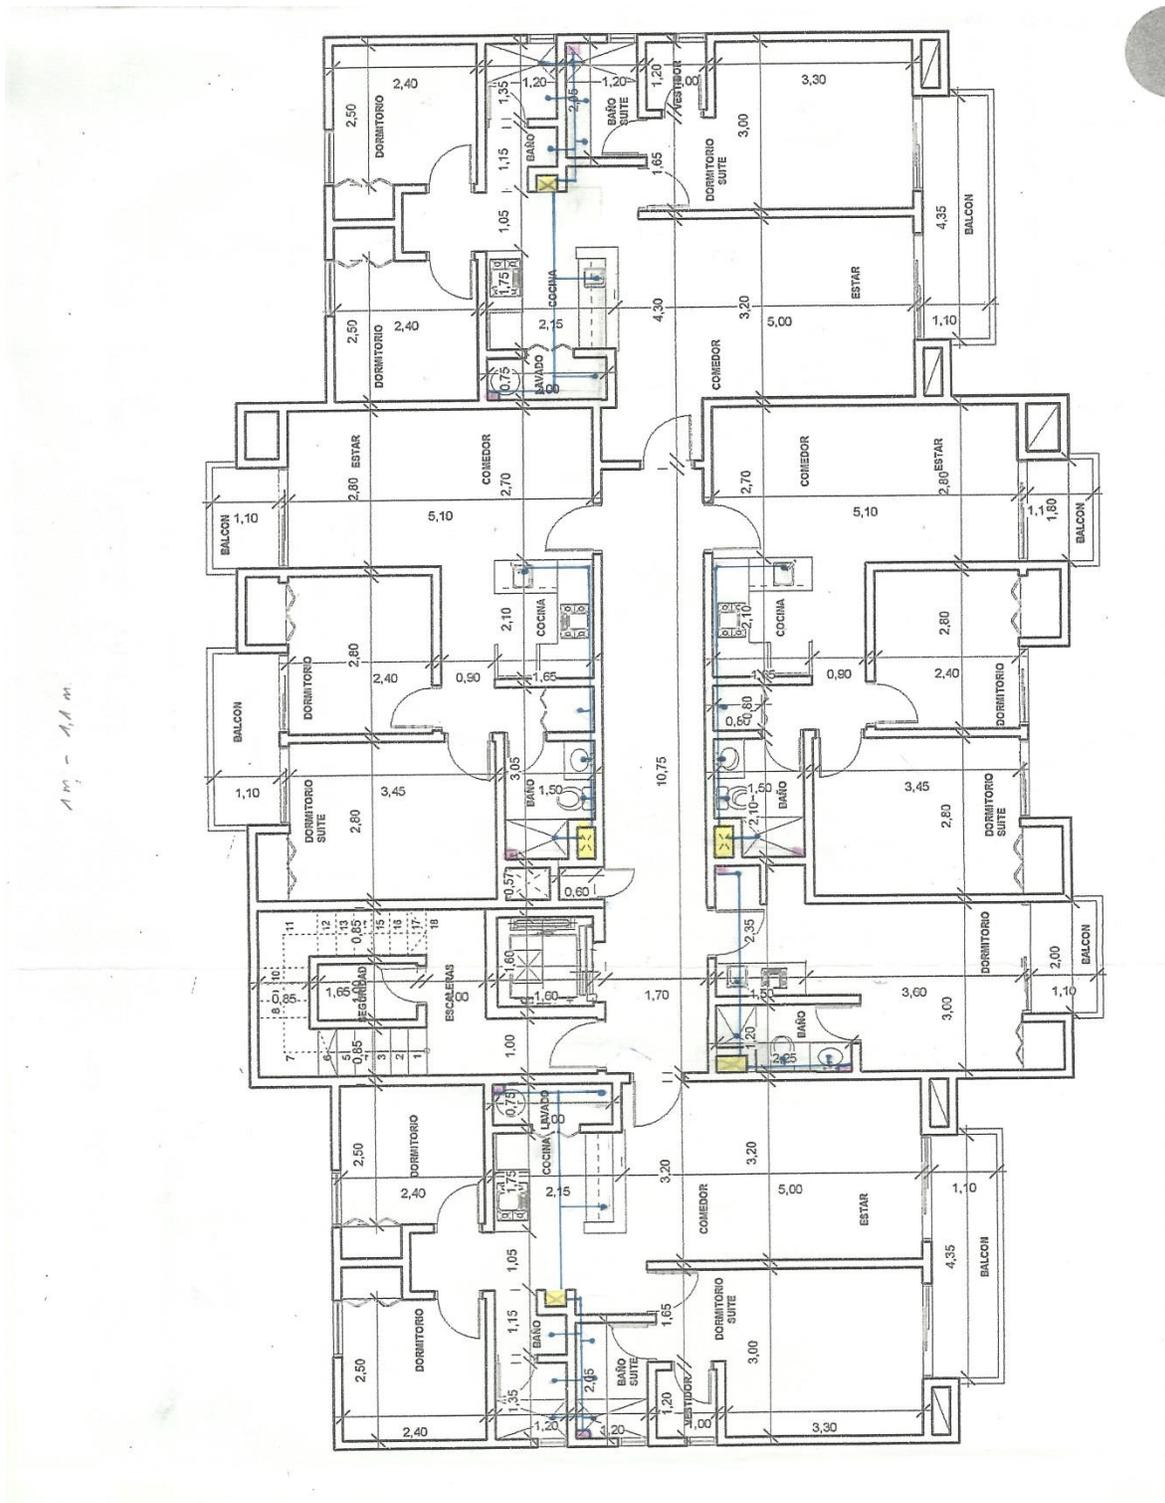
Plano Instalación Sanitaria Piso 2 al 6
